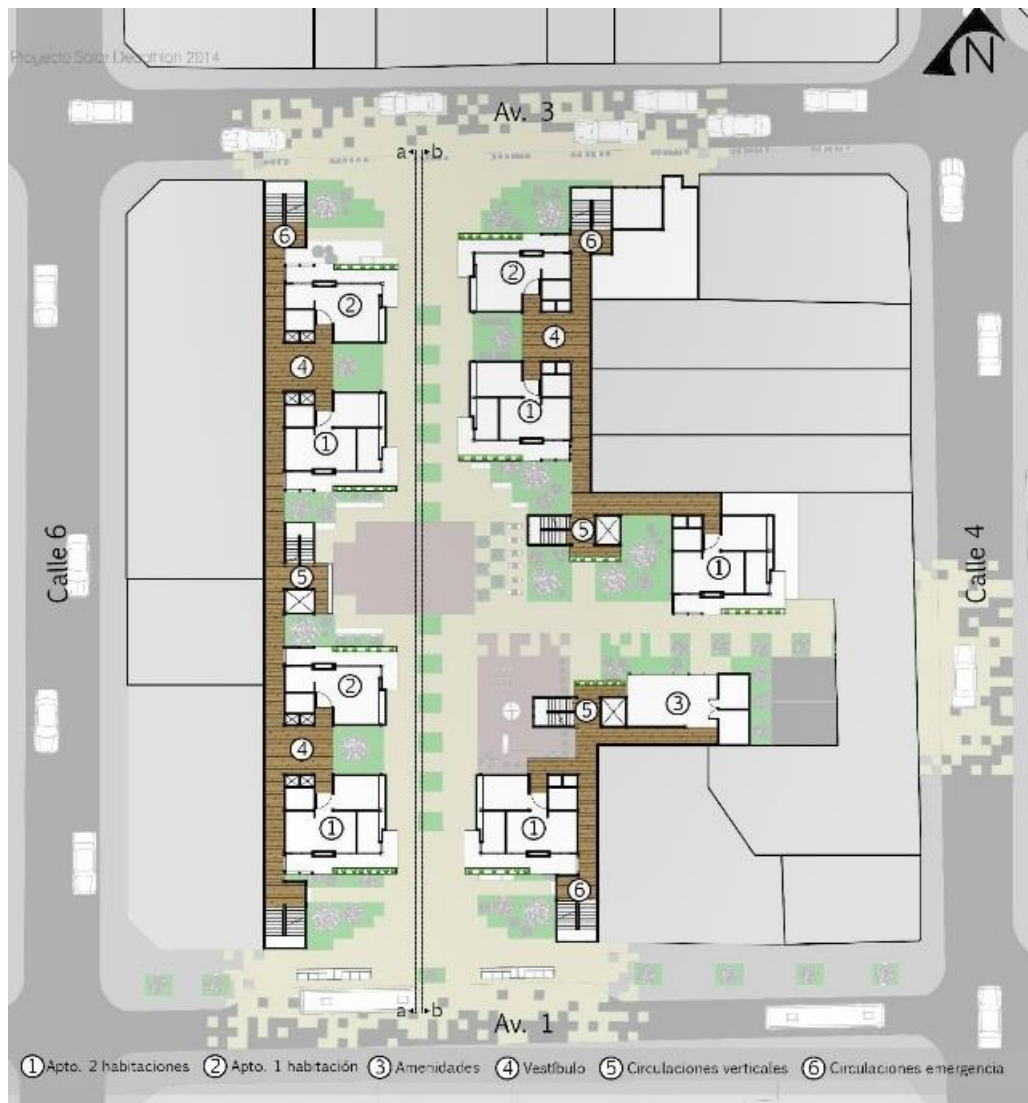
Distribución en planta de los apartamentos en el Proyecto Trópika (Tomado de Salazar *et al.* 2014).
